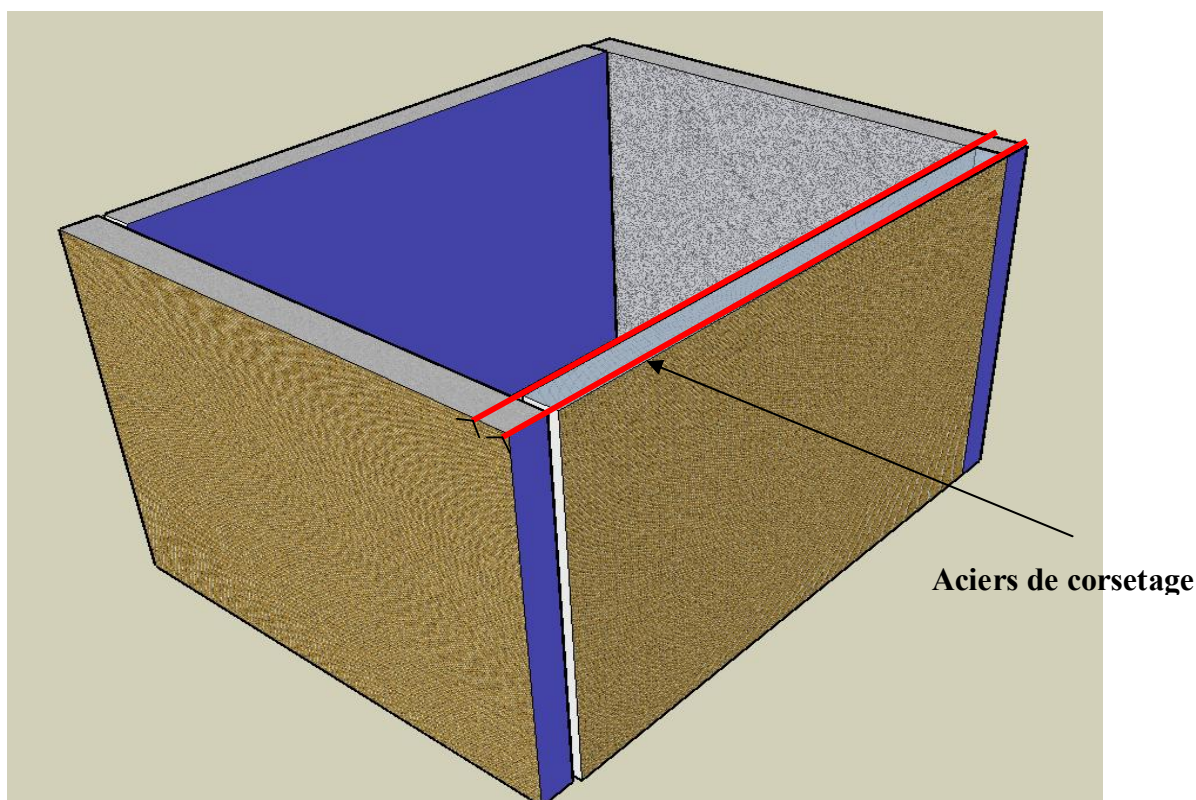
Emplacement des aciers de renforcement pour un panneau de la construction
